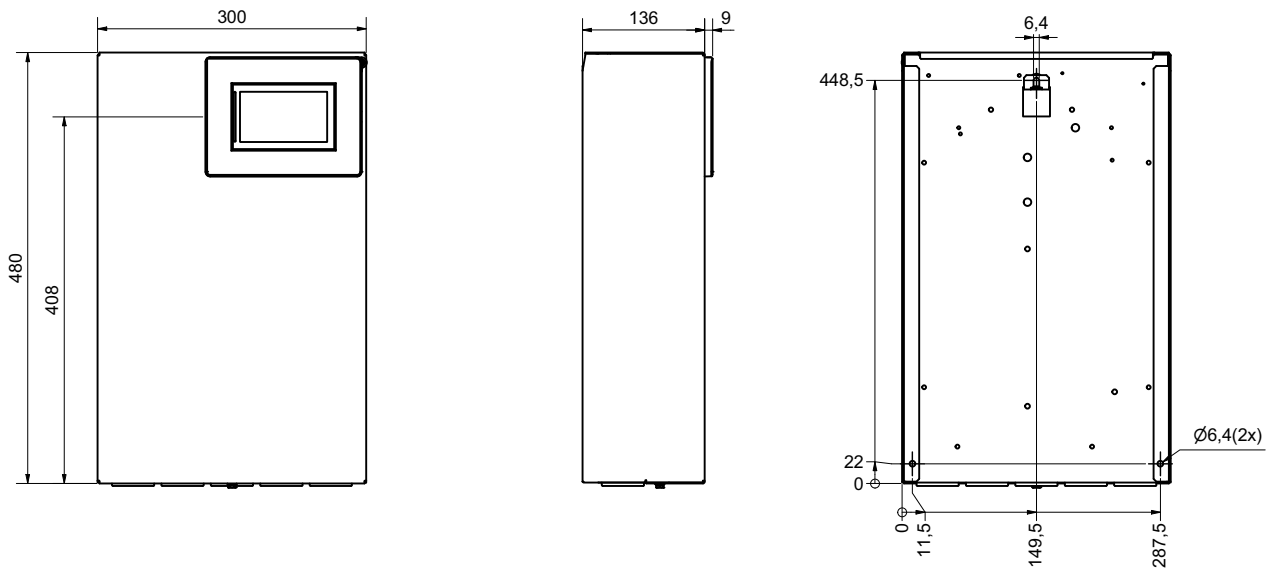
Dimensions of the wall-mounted heat pump manager (heating)
